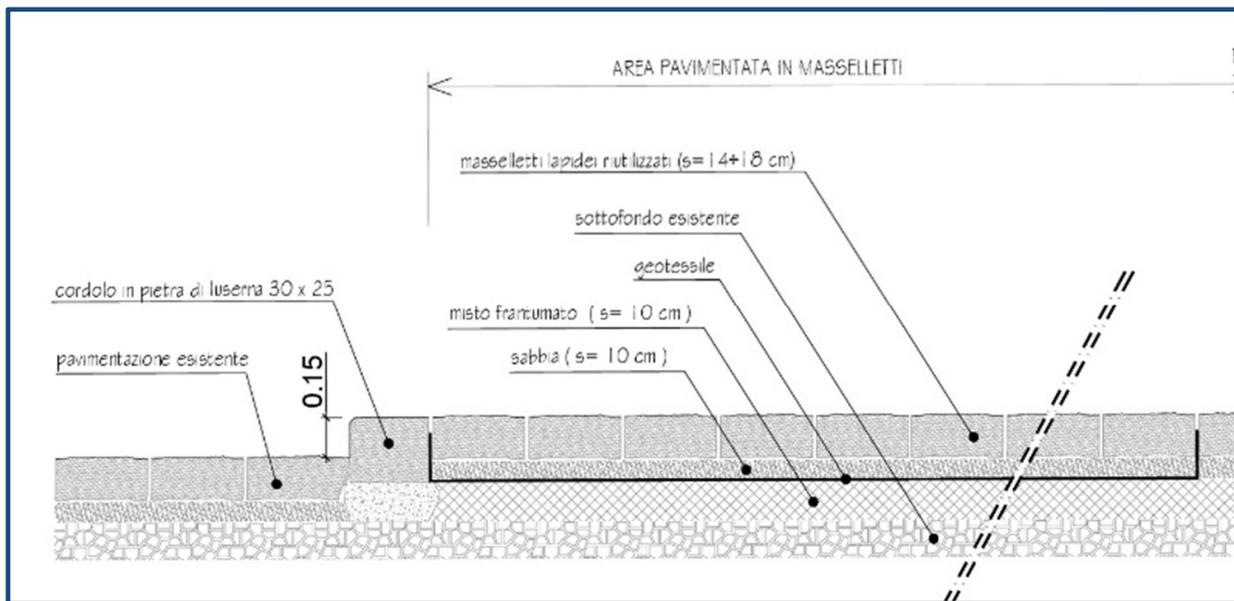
Lotto 1 Piazza stratigrafia di progetto pavimentazione in masselli
